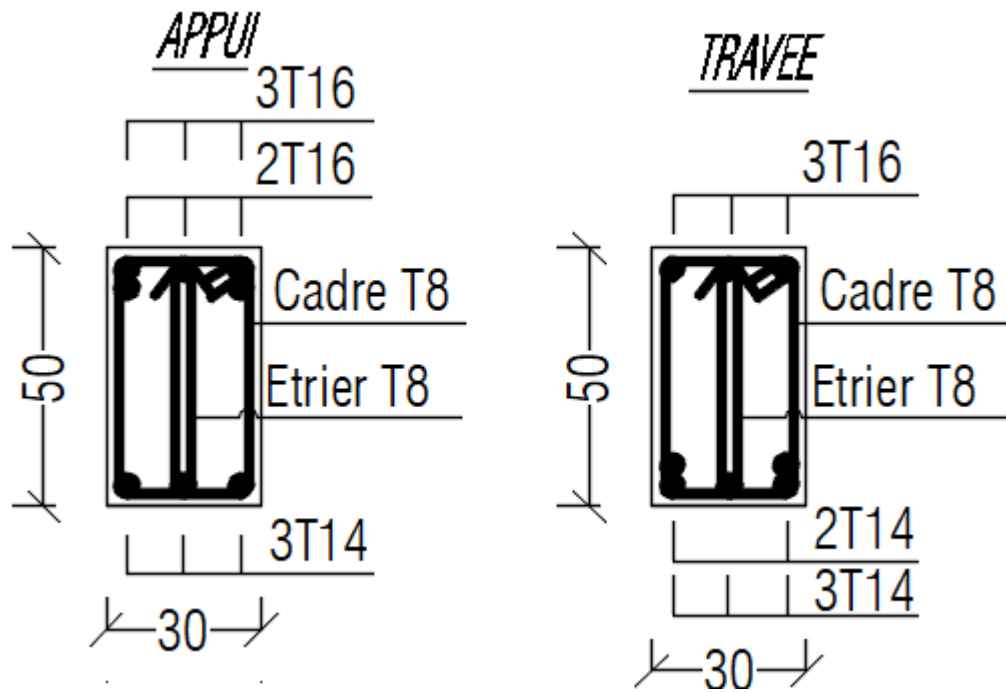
Schéma de ferrailage de poutre principale 30x50.
